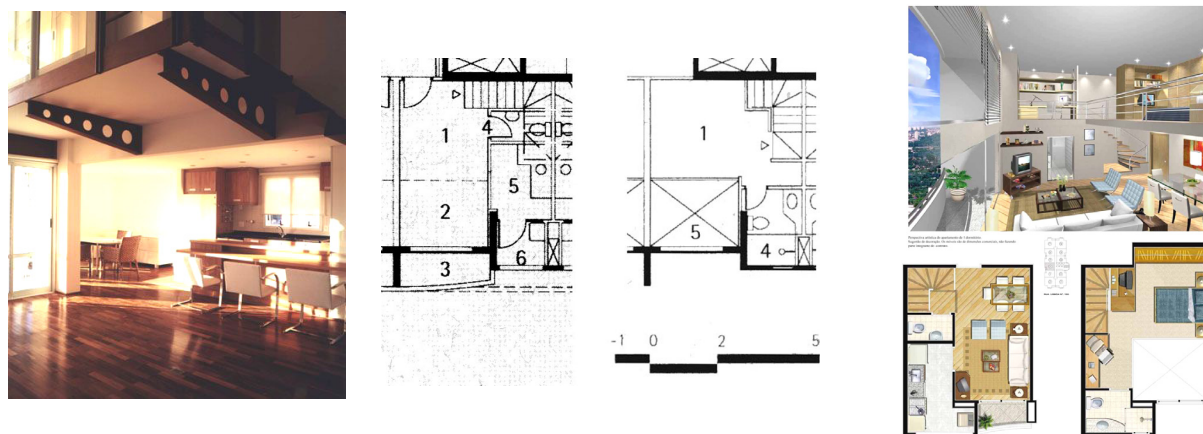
Foto interna de UH do Ed. Living Loft (VA-07). Planta tipo de UH do Ed. Duplex Top Tower (VA-08). Planta tipo de UH do Ed. Helbor Loft Evolution (VA-09).
